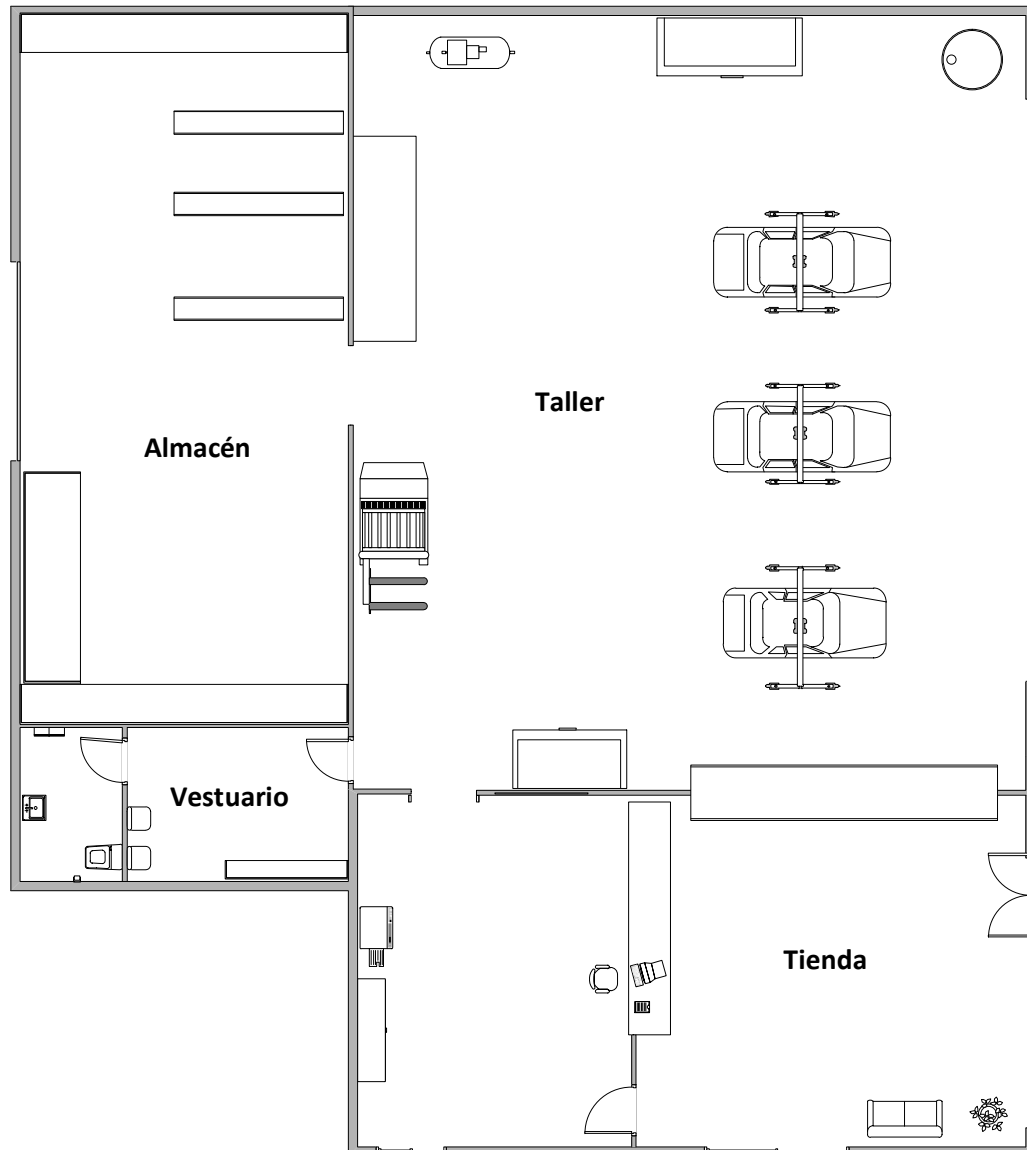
Distribución en planta de las instalaciones de Talleres Carwork.
